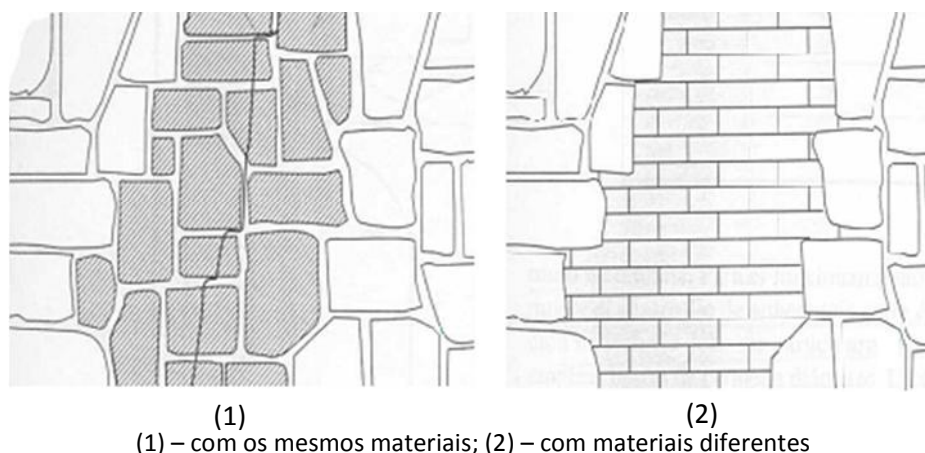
Representação esquemática de desmonte e reconstrução de elementos degradados [35]
